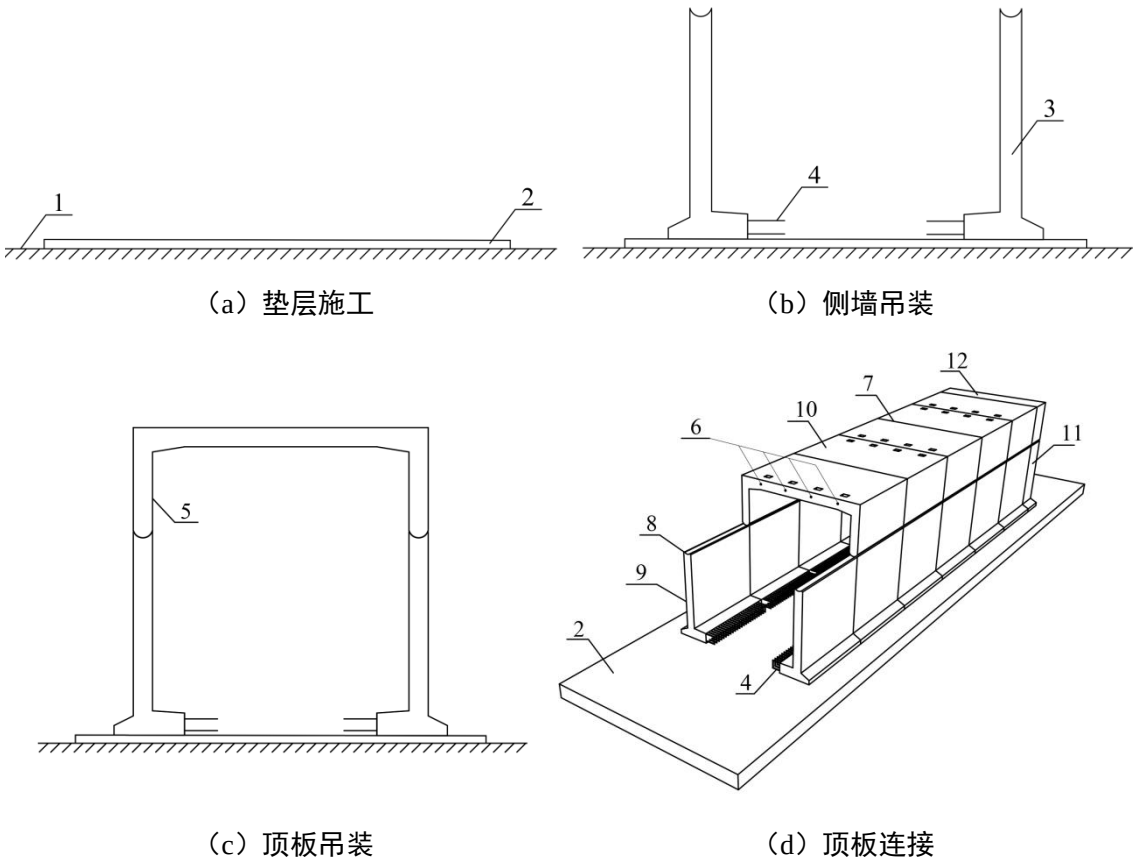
整体式预制钢筋混凝土箱涵现场安装示意图
